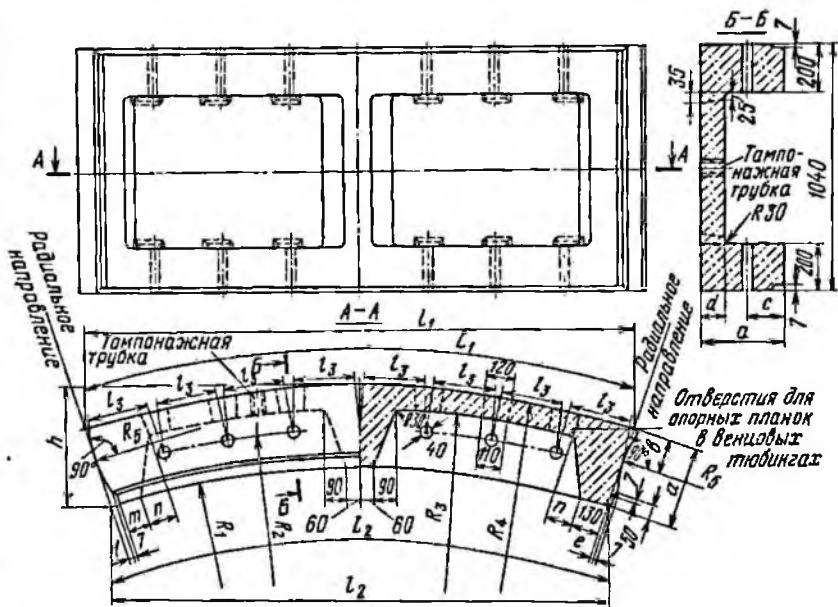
Железобетонный тунннг конструкции ВНИИОМШСа
